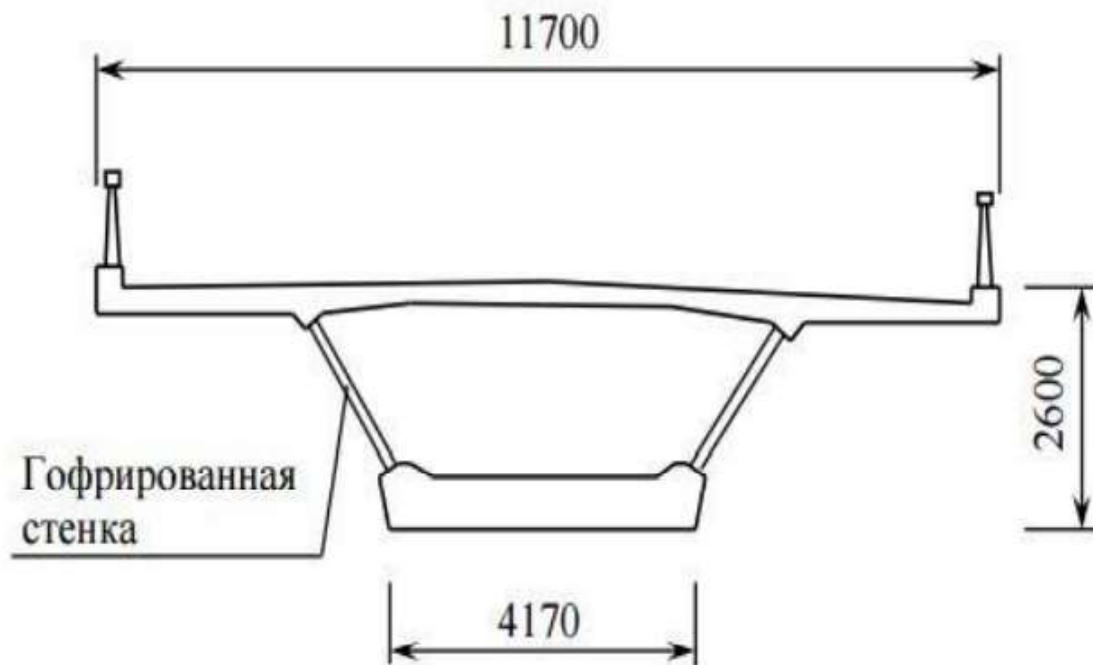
Поперечний переріз мосту Cognac bridge (Франція)
